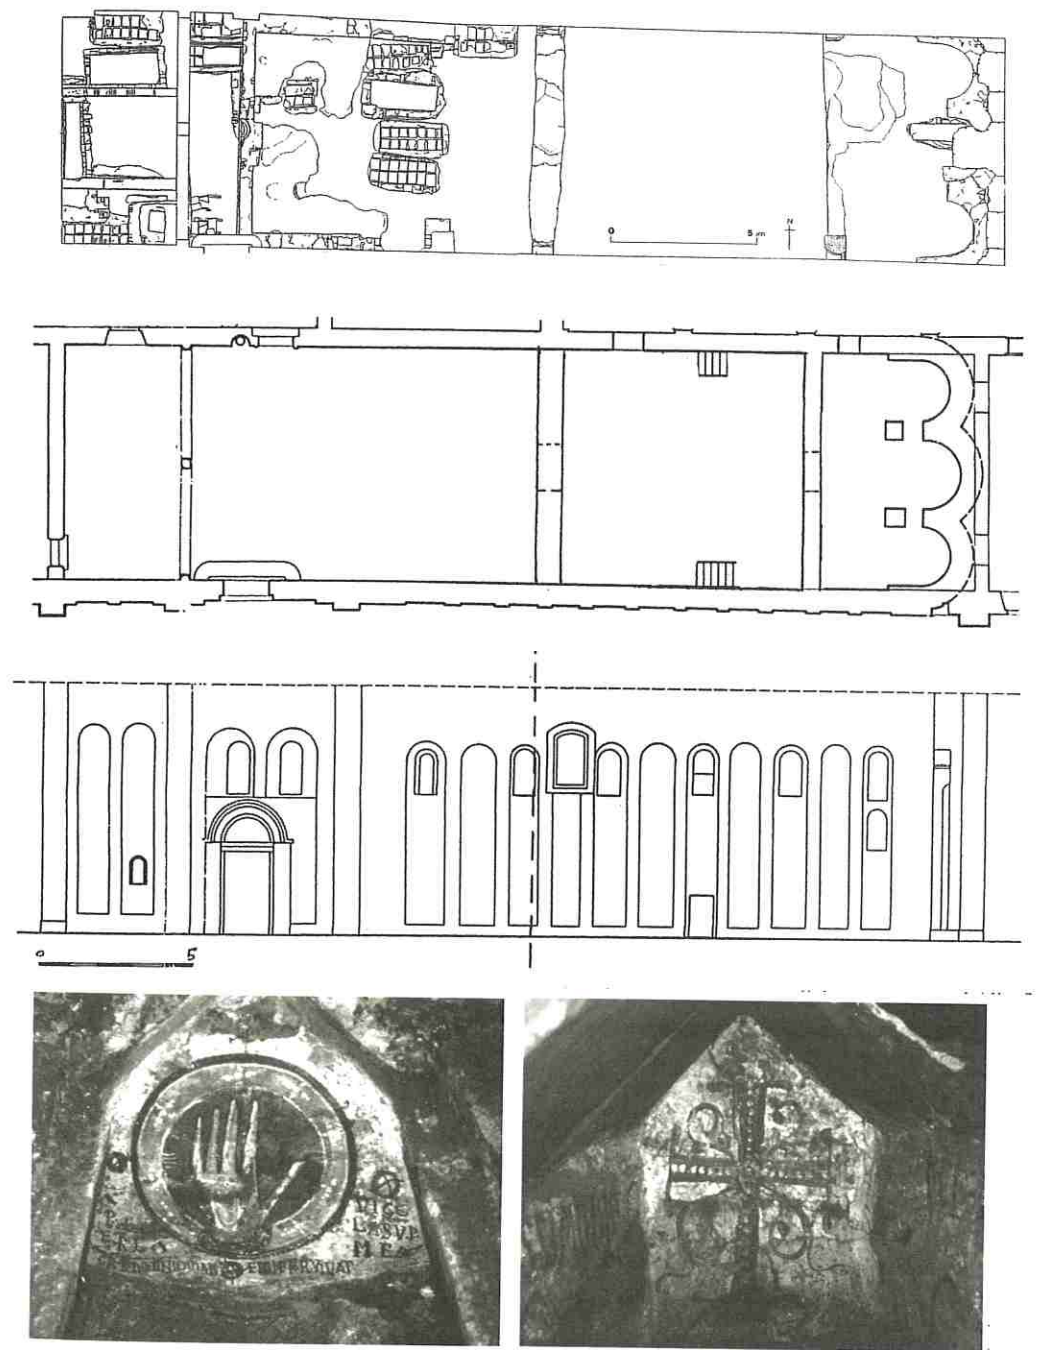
Pavia, San Salvatore e Santi Pietro e Paolo, rilievo di scavo, planimetria e prospetto schematici, tombe dipinte (da Lomartire 2003).
